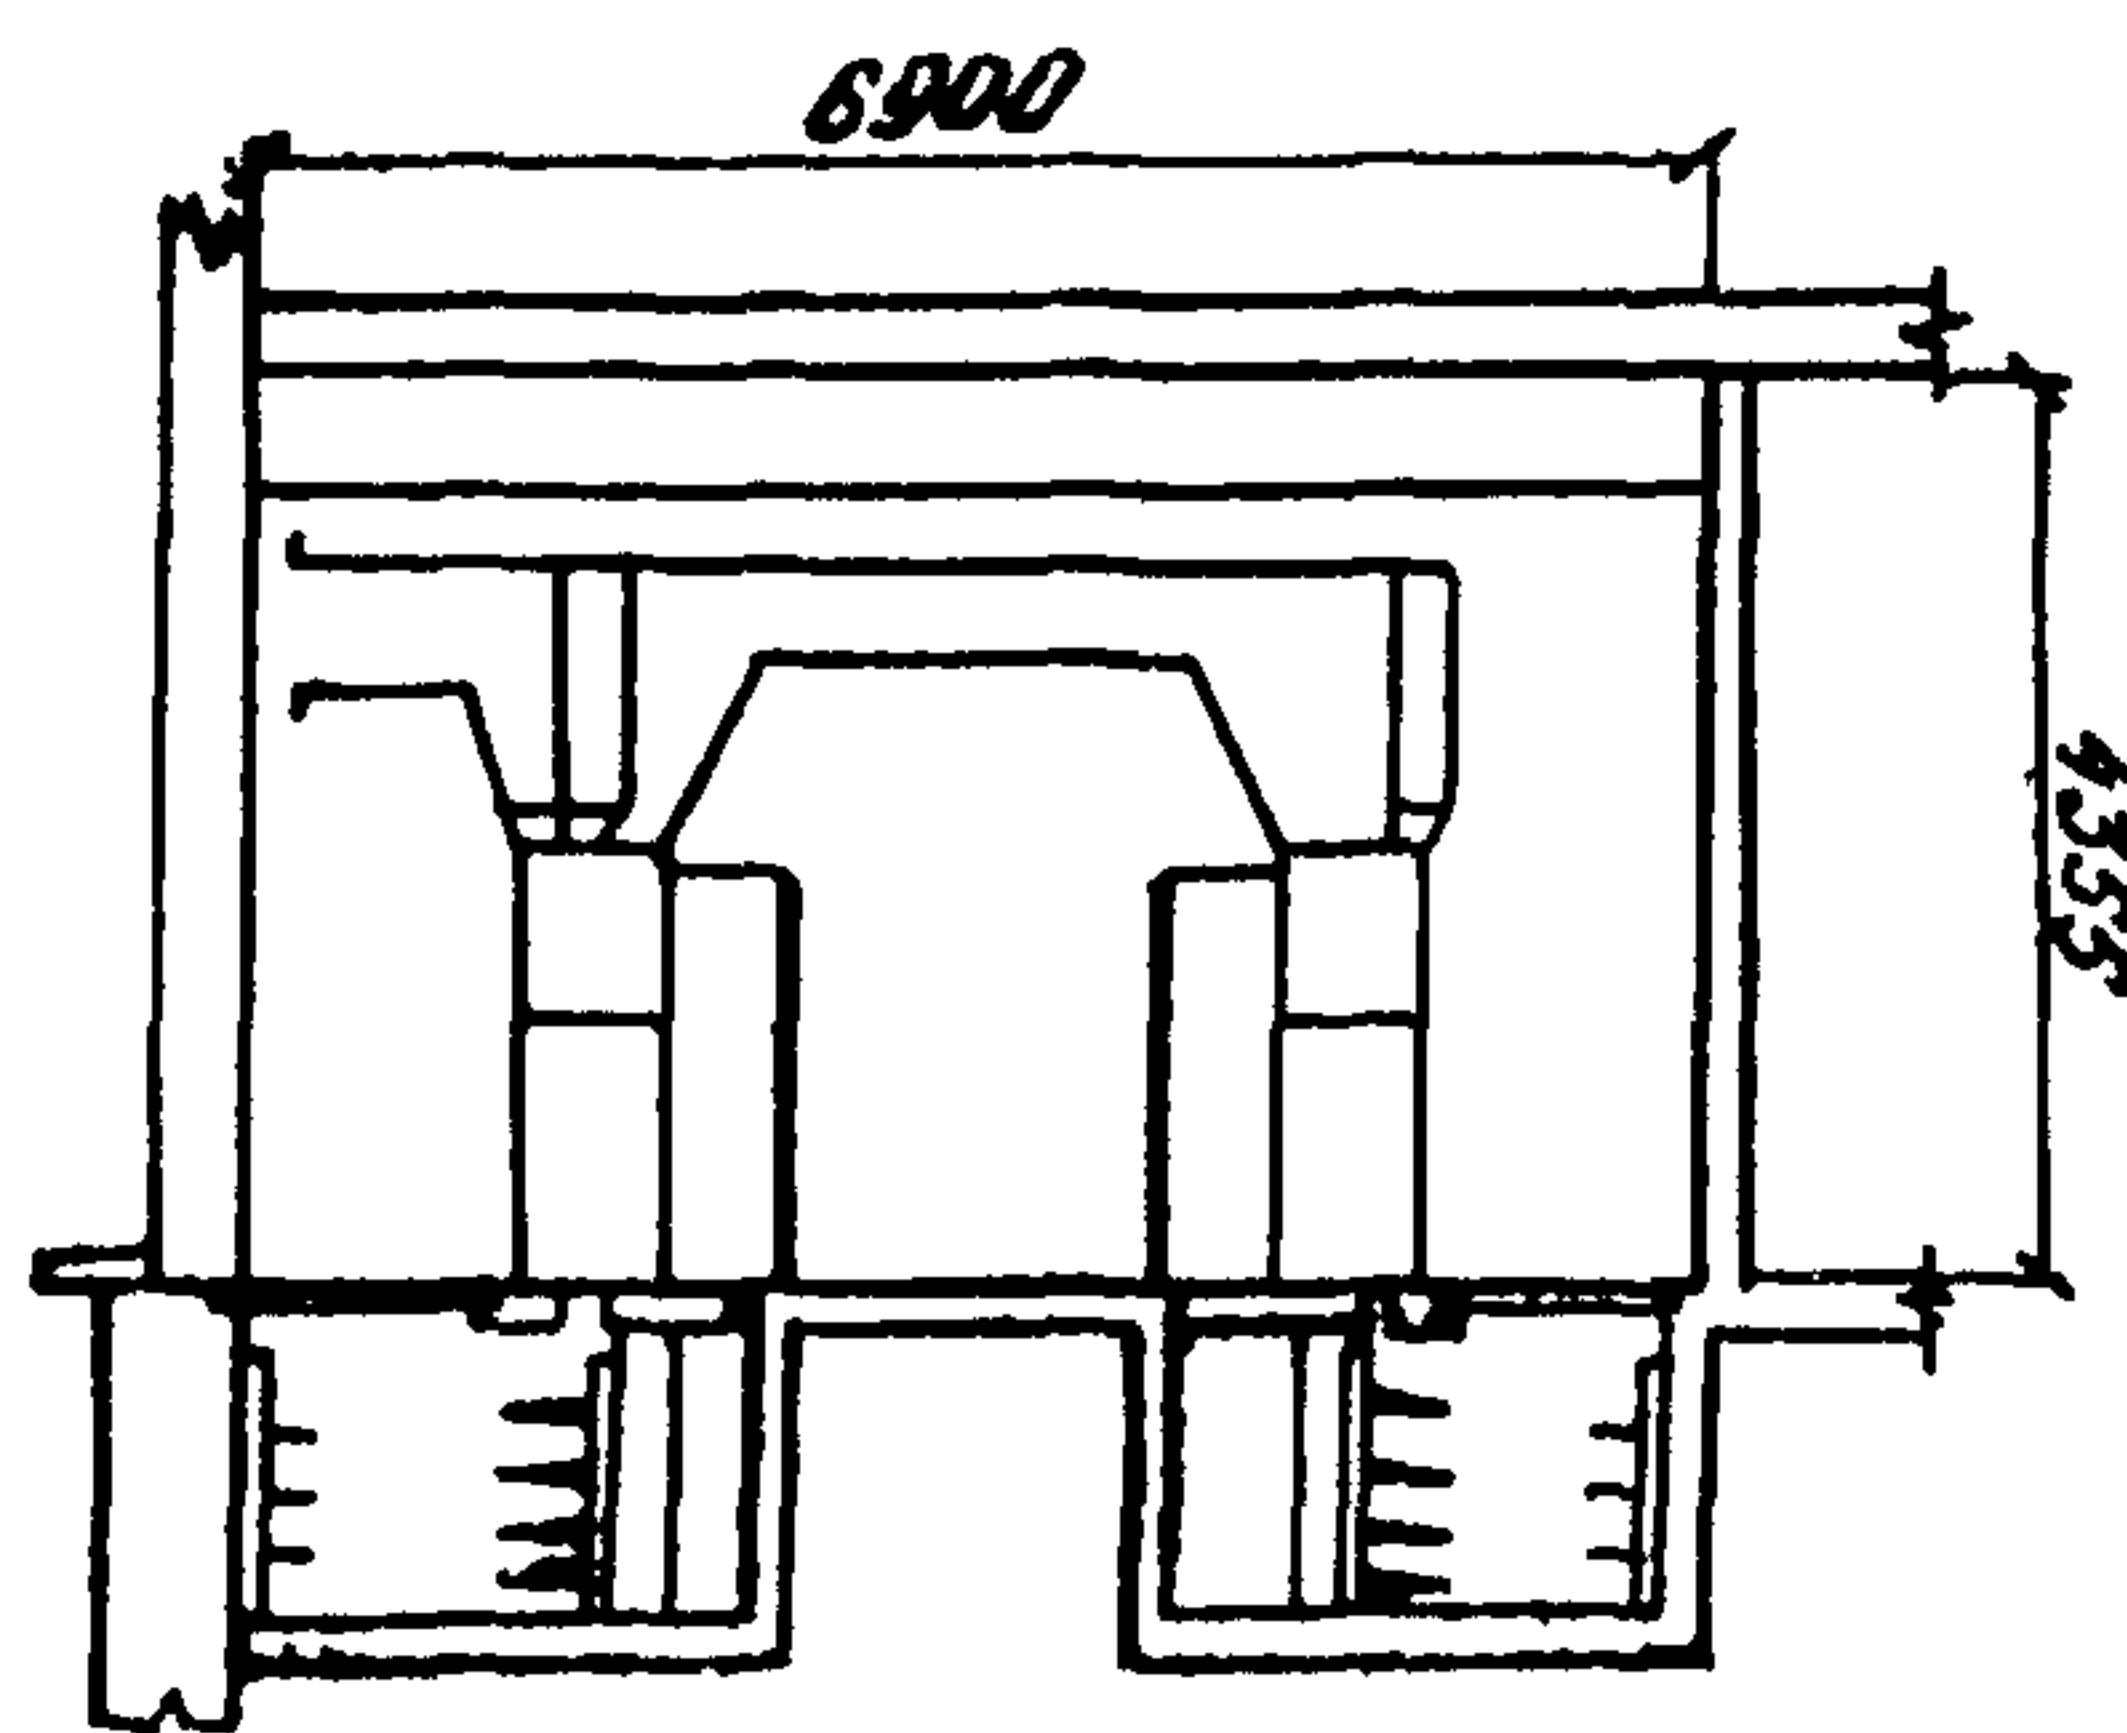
План размещения оборудования и механизмов при монтаже шкафов КРУ:
